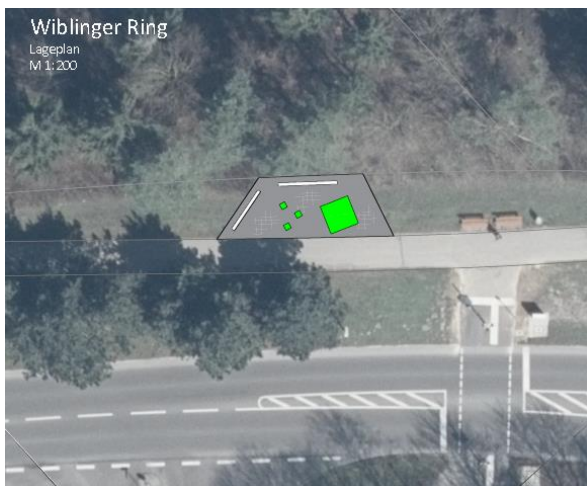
Lageplan Unterstand Jugend, Quelle: Stadt Ulm
